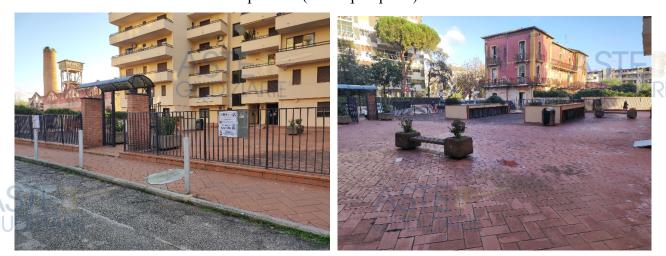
e 24: Pavimentazione condominiale sovrastante deposito pignorato (dalle oper. perit.)
